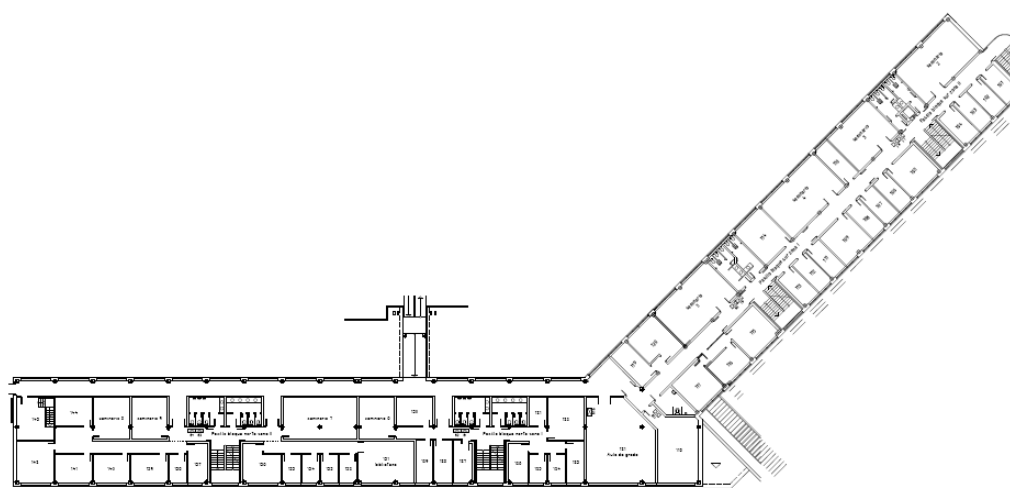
Vista en planta de los espacios en la actual ETSII (Edificio II – Zona II)
